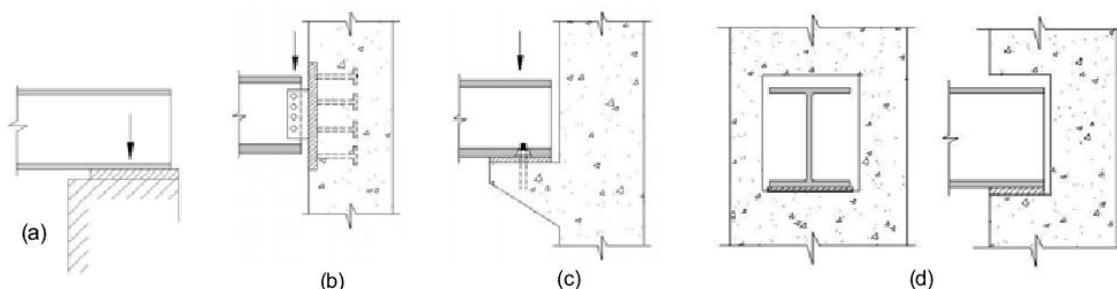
Tipos de apoio aço-concreto - soluções durante a construção.
